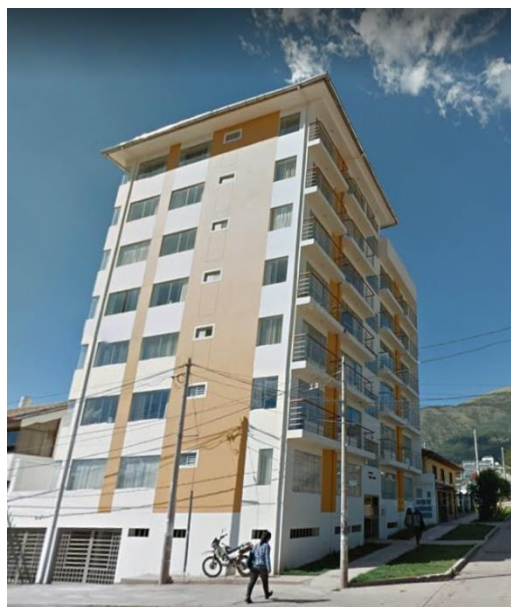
Edificio multifamiliar Torre Zafiro, Urb. Larapa se visualiza un edificio de 7 niveles con semisótano una cimentación superficial de losa de cimentación.
